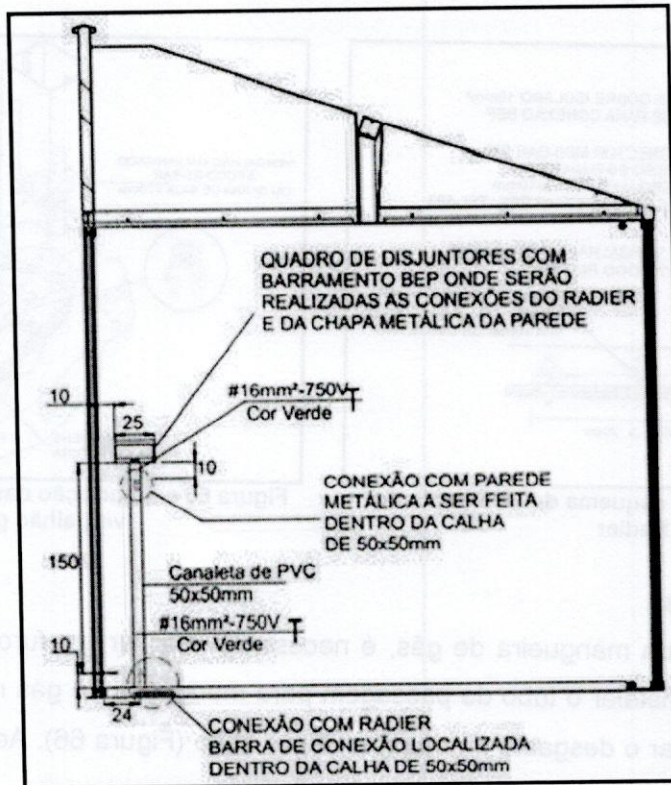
Conexão Barramento BEP x Radier x Chapa Metálica do Painel
